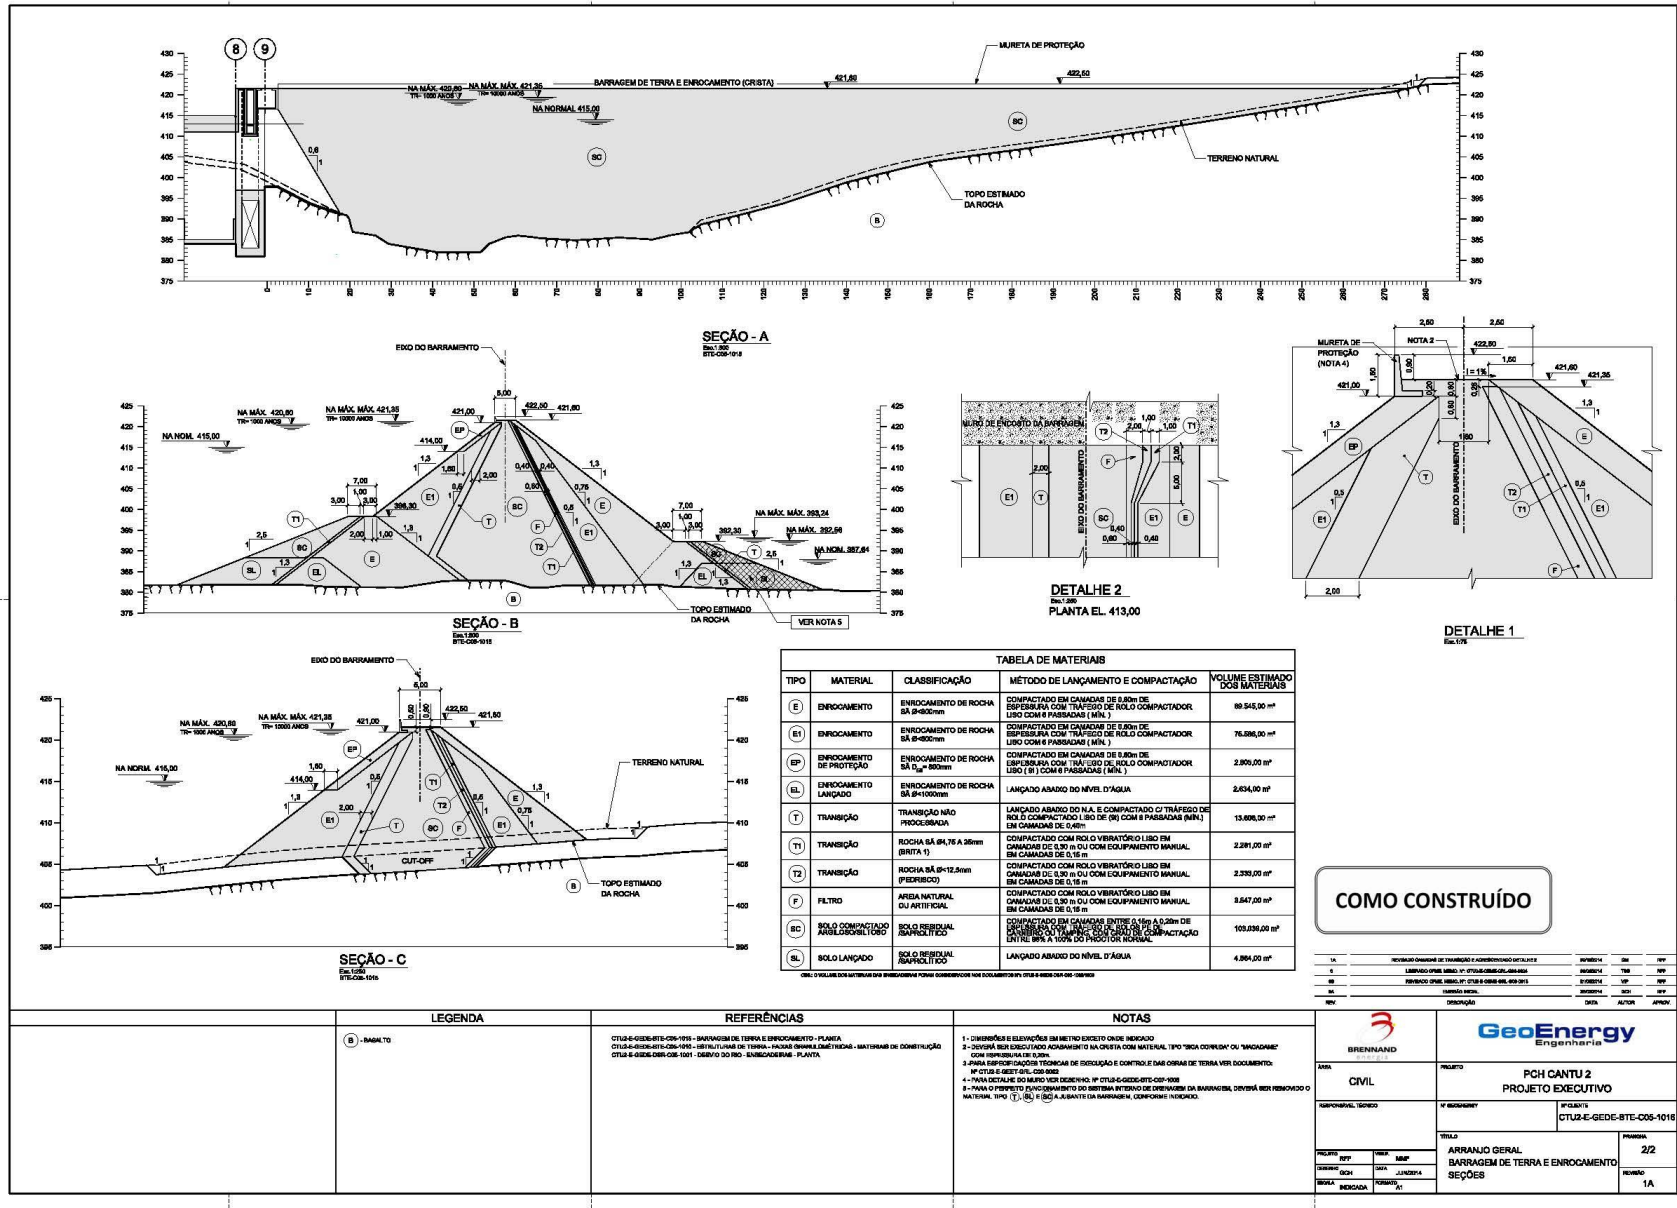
Barragem Enrocamento c/Núcleo – Seção
